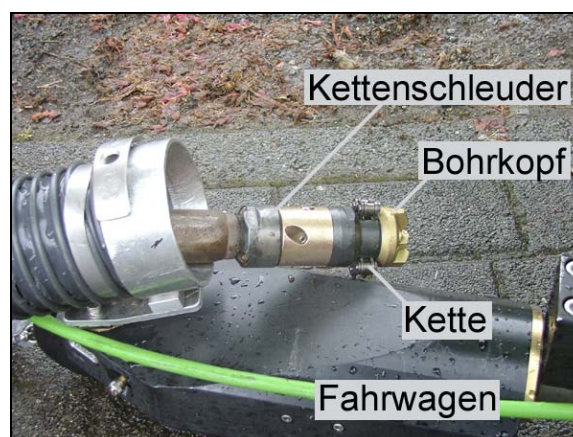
HD-Kettenschleuder im SPE-System [8]. Die Kettenschleuder besitzt neben rückwärts gerichteten Düsen für den Vortrieb einen frontalen Bohrkopf und Ketten die durch den Wasserdruck in Rotation gebracht werden.
